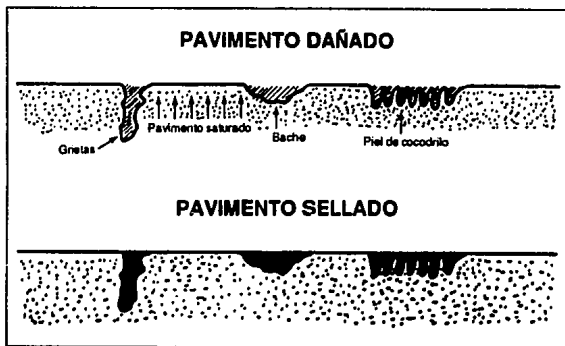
Pavimento antes y después de la aplicación del sello asfáltico.
